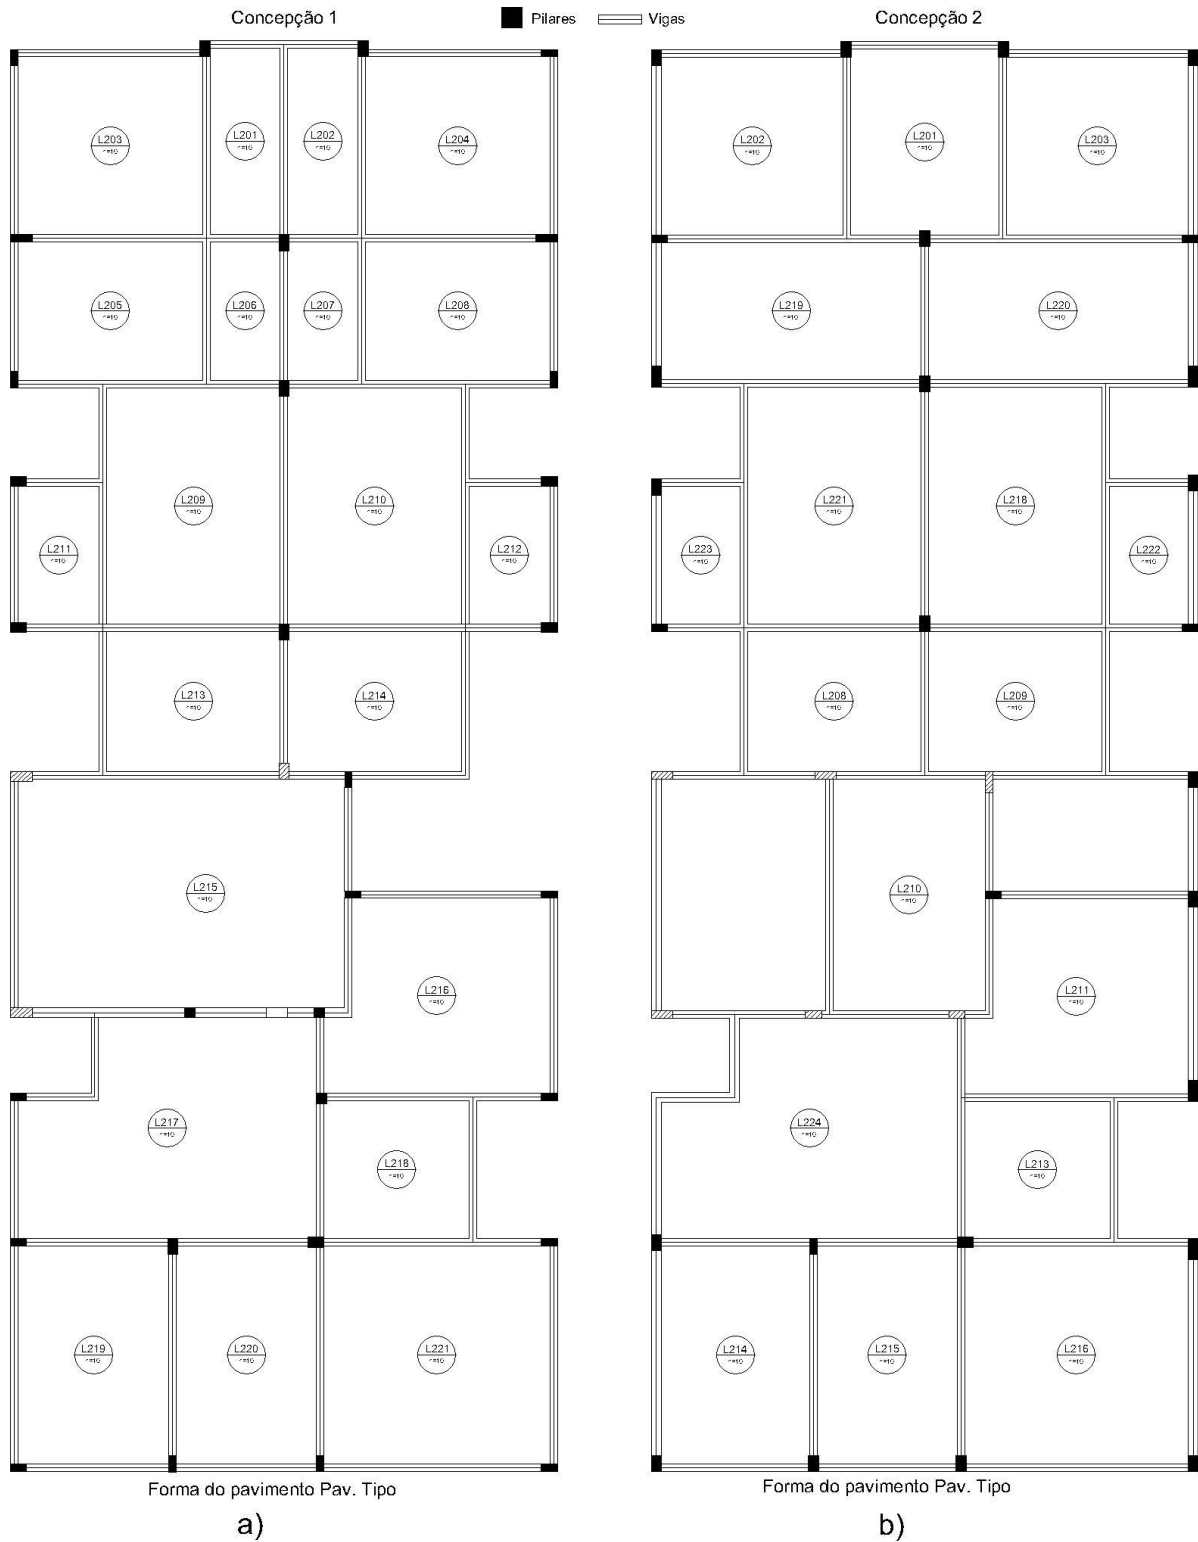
Planta de forma do Pavimento Tipo: a) Concepção 1; b) Concepção 2
